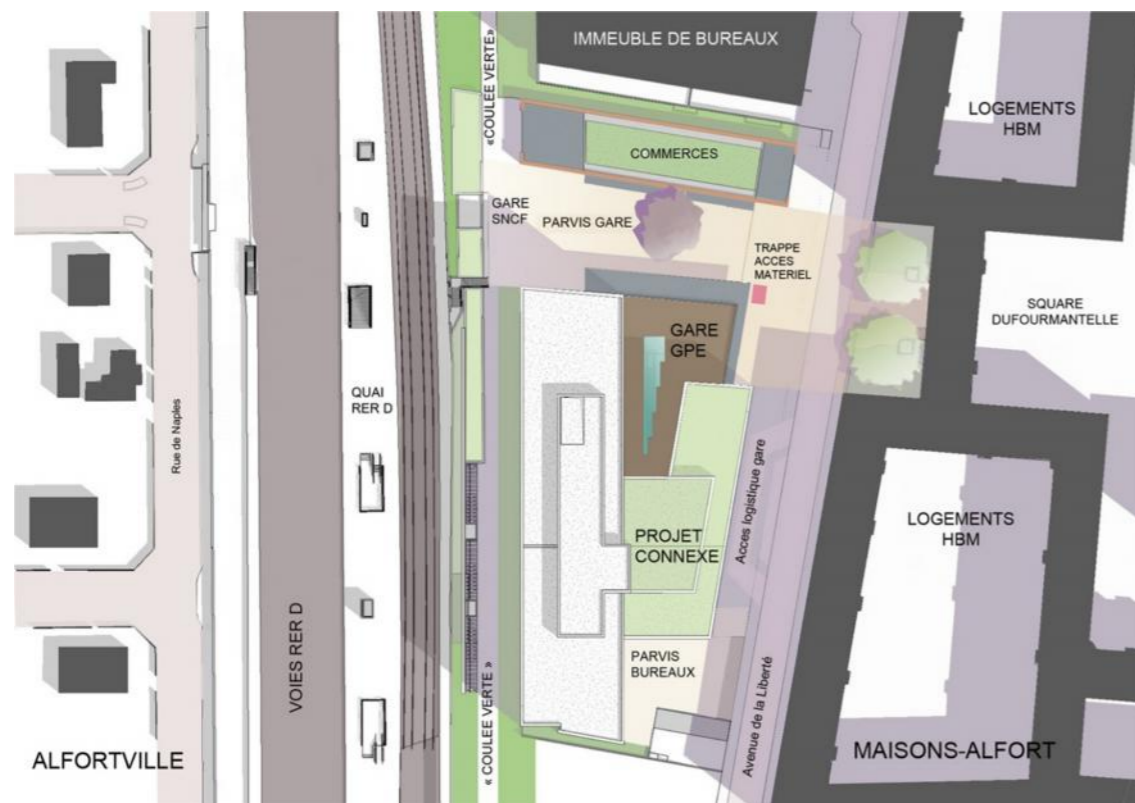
Plan masse à l'échelle 1/500ème - VPA. 23/12/2014
